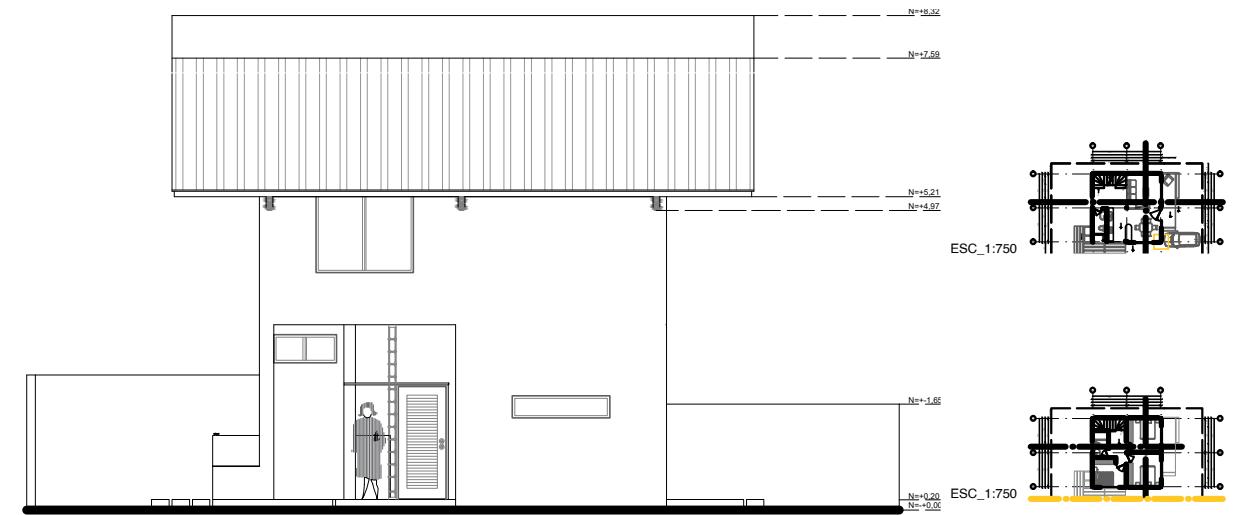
[Figura] Tipología 3 de prototipo de vivienda con el sistema constructivo bahareque encementado. Fuente: Autor.
